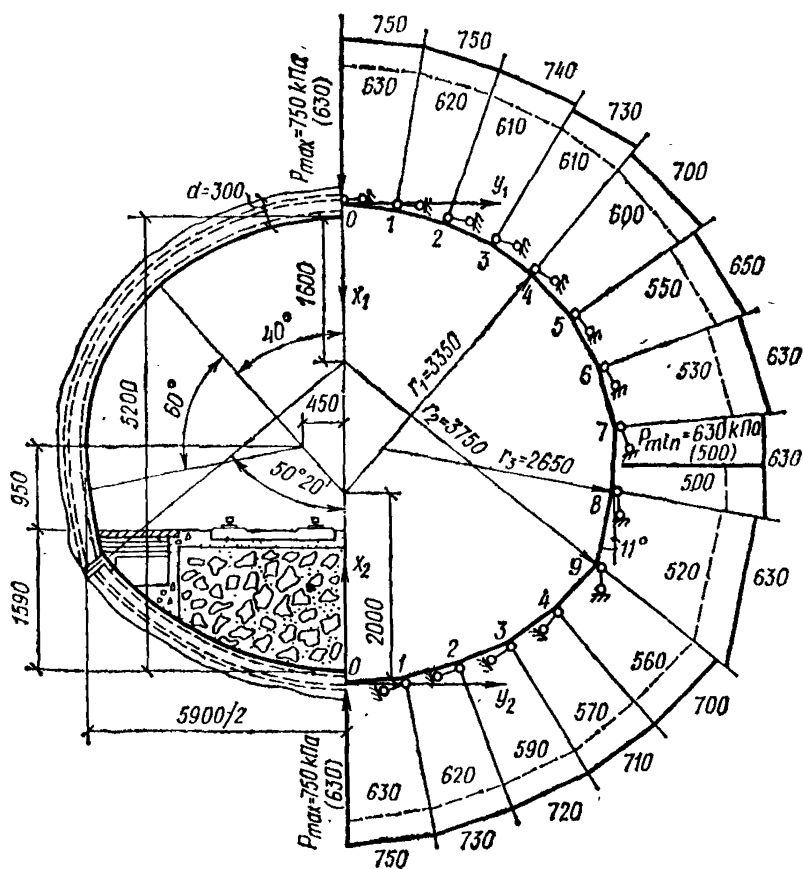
Очертание и расчетная схема замкнутой железобетонной крепи с жесткой арматурой и выложенными сводами
